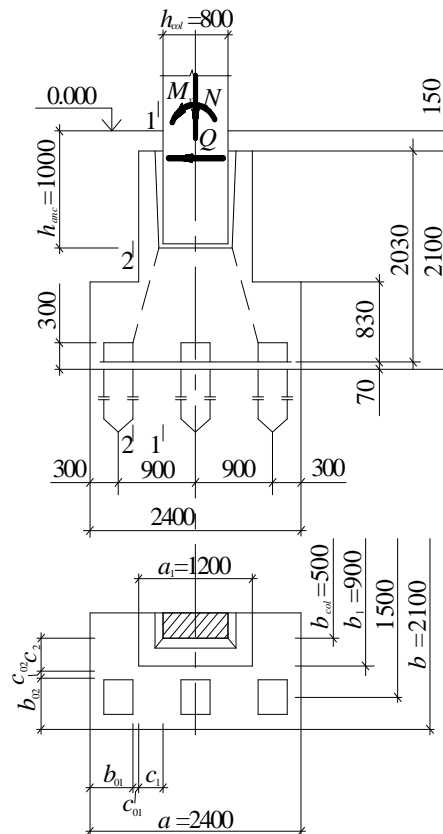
Пальовий фундамент на середню залізобетонну колону
